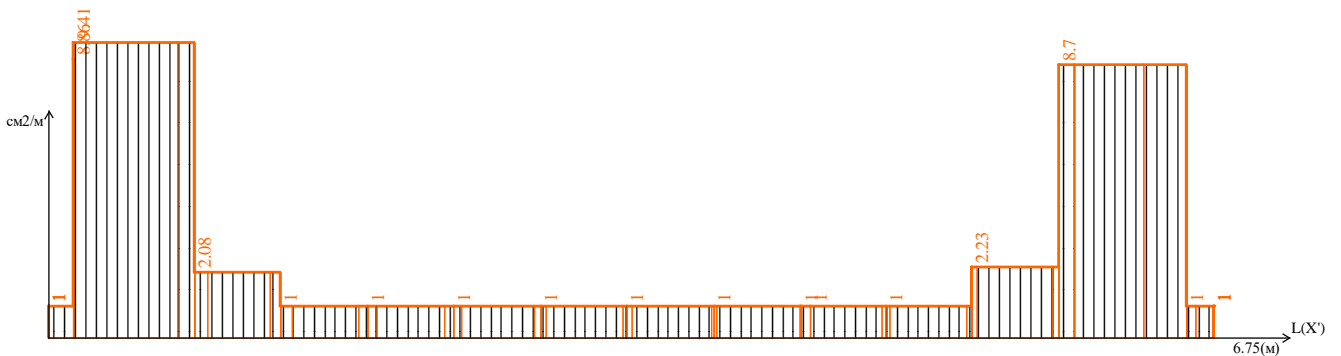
Нижнее армирование перекрытия в осях А-Б
